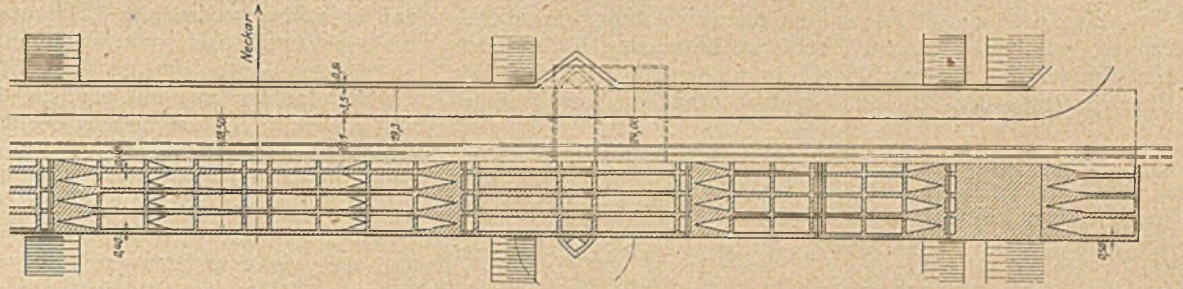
Grundriß oben mit Fahrbahn, unten ohne Fahrbahn.
